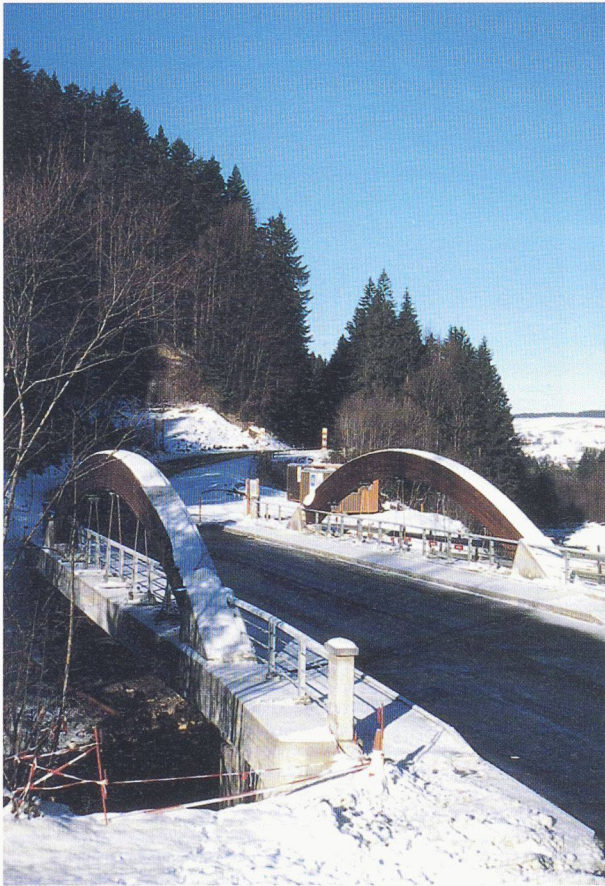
Vue d'ensemble du nouvel ouvrage
